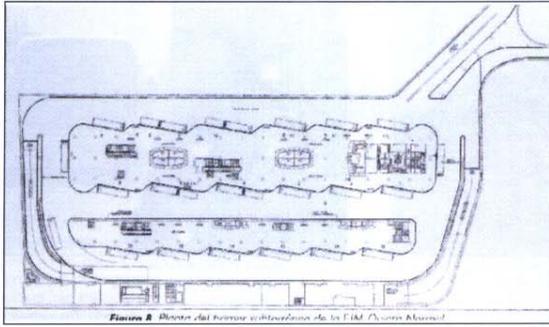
Planta del primer subterráneo de la EIM Quinta Normal
